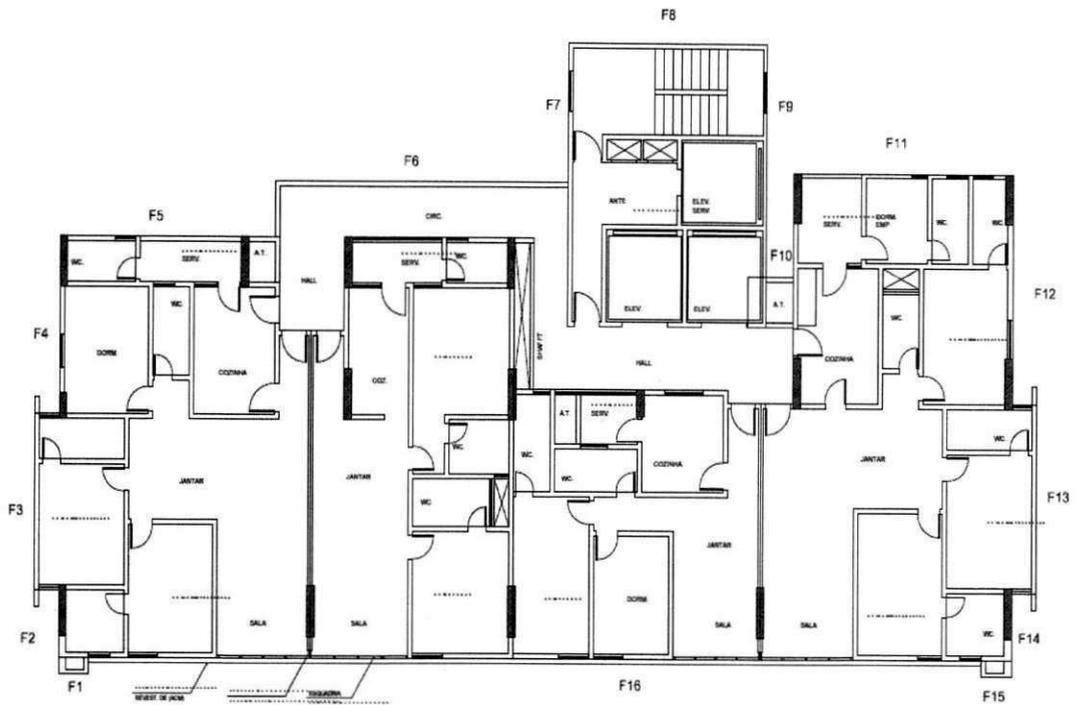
Planta baixa - Mundo Plaza (Bloco B).
